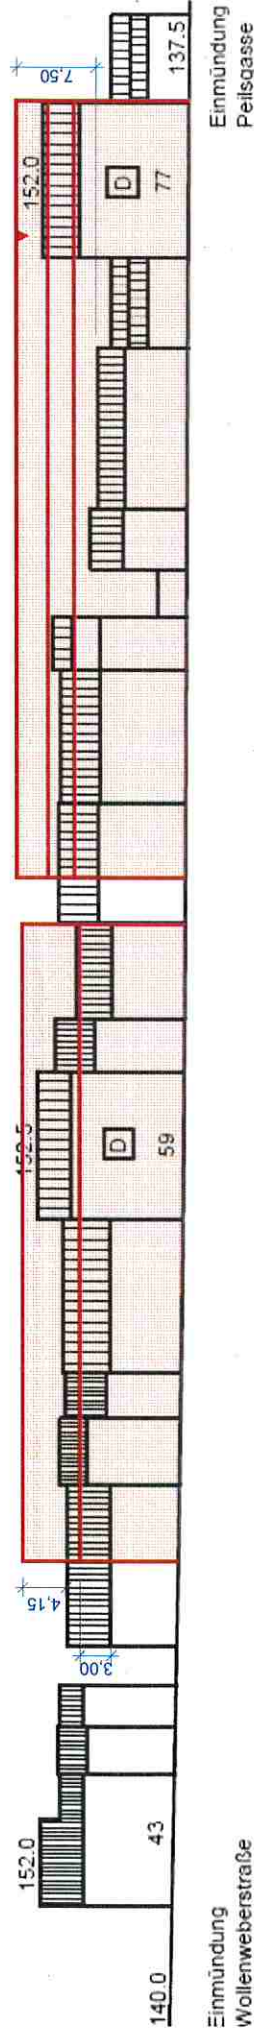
Schematische Fassadenabwicklung Dürener Str./Nordseite, Höhenangaben näherungsweise in m ü NHN [Quelle: Stadt Eschweiler]
